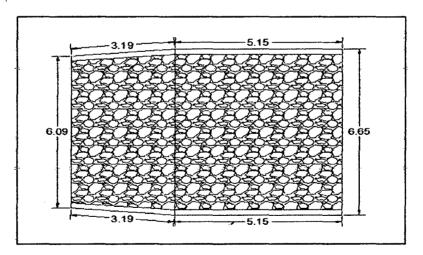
Planos de detalle del Emboquillado km 118+490. Fuente: Datos de Obra.
